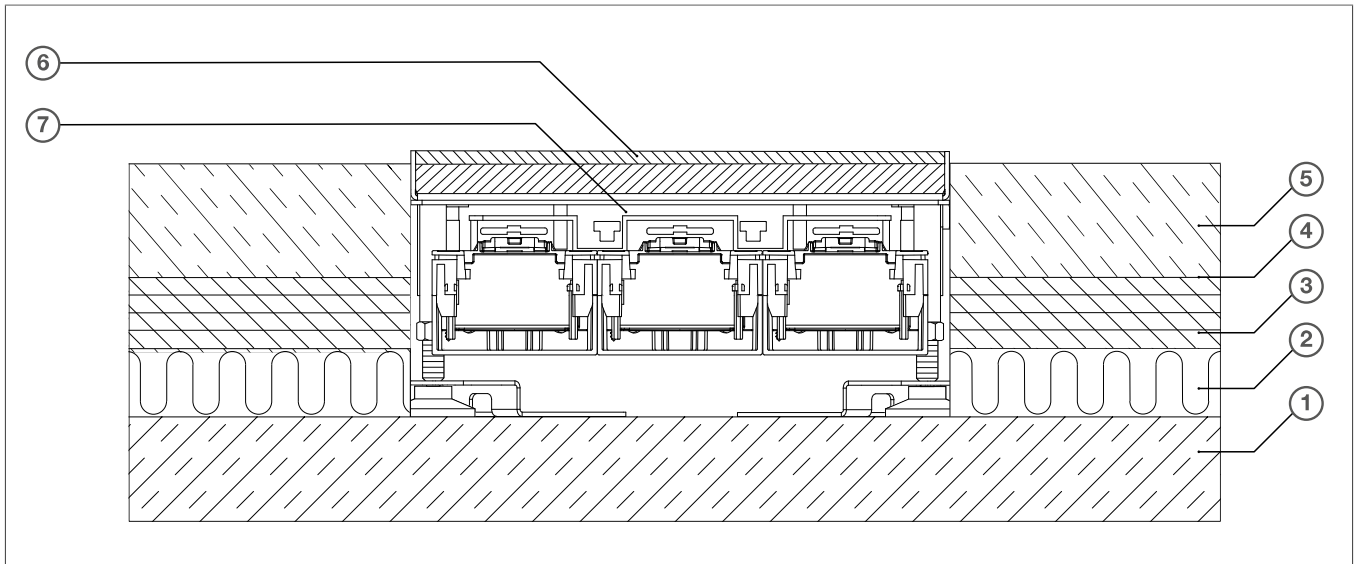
Prinzipskizze Prüfaufbau nivellierbare Kassette EKQx im Deckenprüfstand
